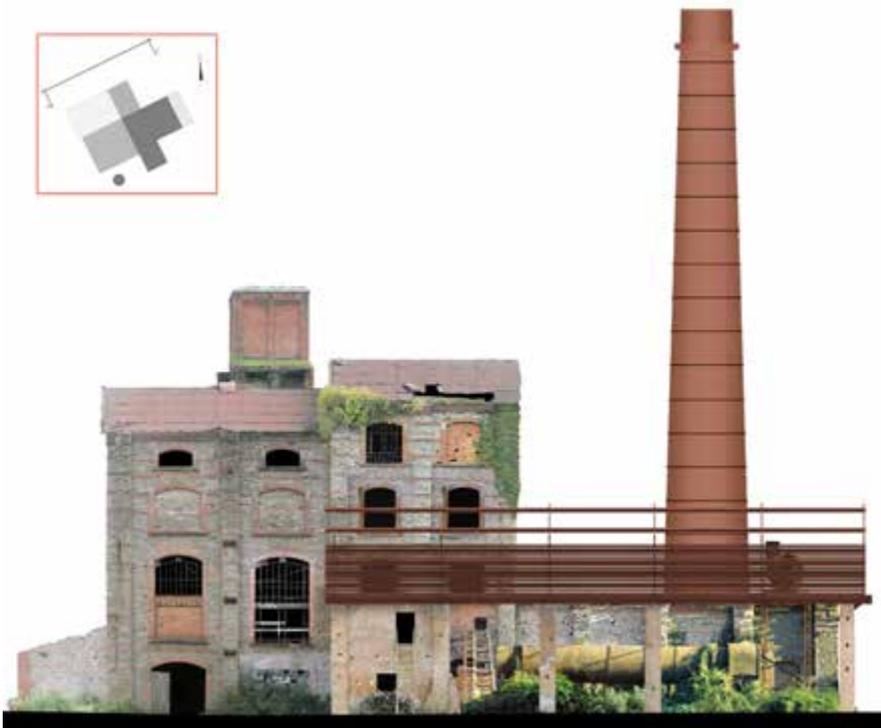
Rilievo, fotoraddrizzamento, prospetto nord-ovest
